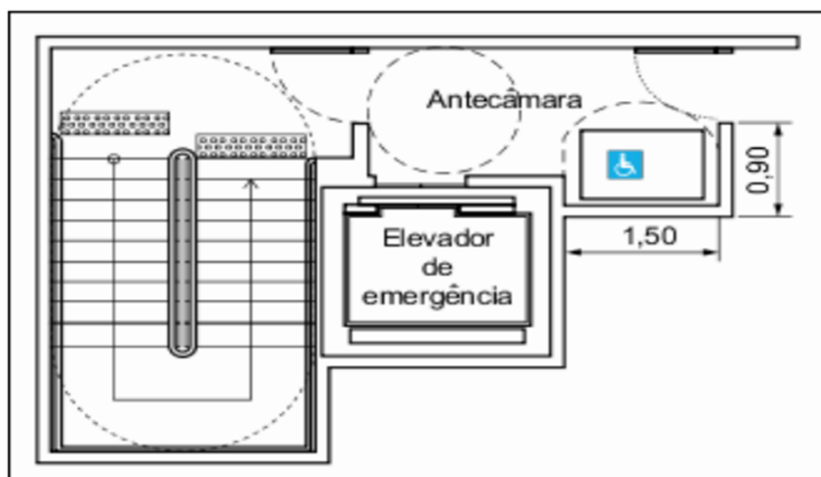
Escada enclausurada à prova de fumaça, com área para pessoas em cadeira de rodas.
